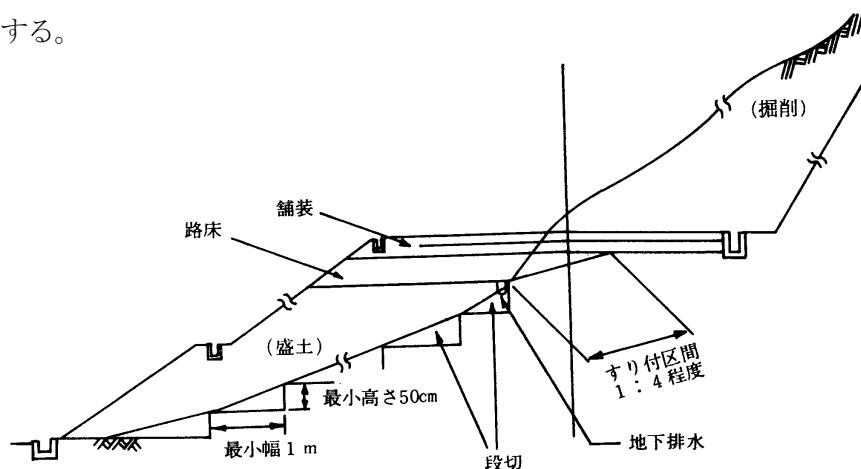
盛土基礎地盤の段切りおよび切土盛土の接続部（土砂地盤の例）
